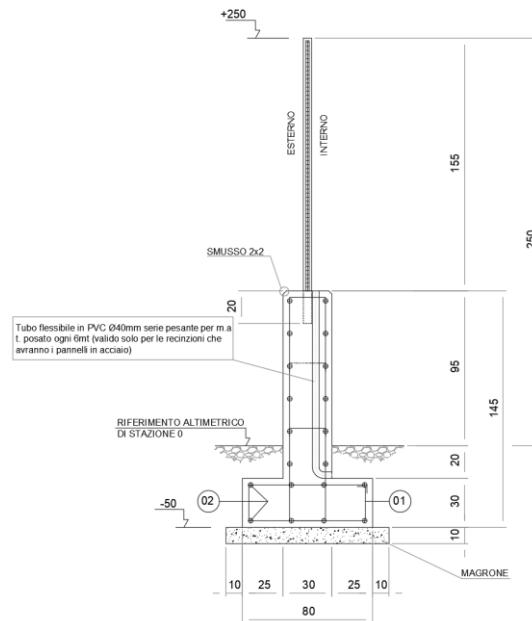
Sezione tipo e prospetti esterni recinzione
